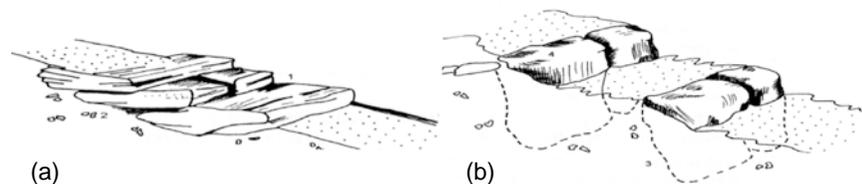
Marches réalisées en dalles (a) ou en blocs de pierres (b)
